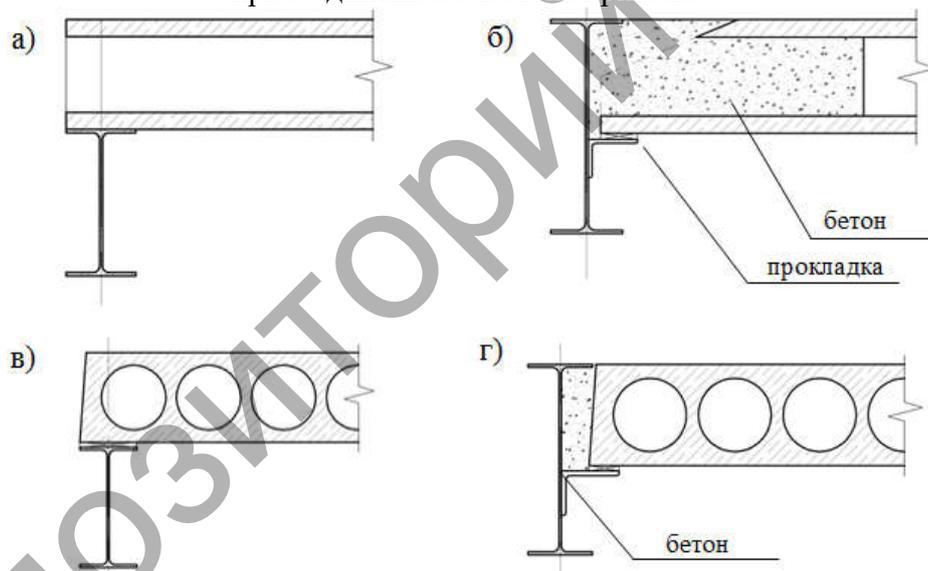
Узел опирания сборной железобетонной плиты на крайний ригель:
